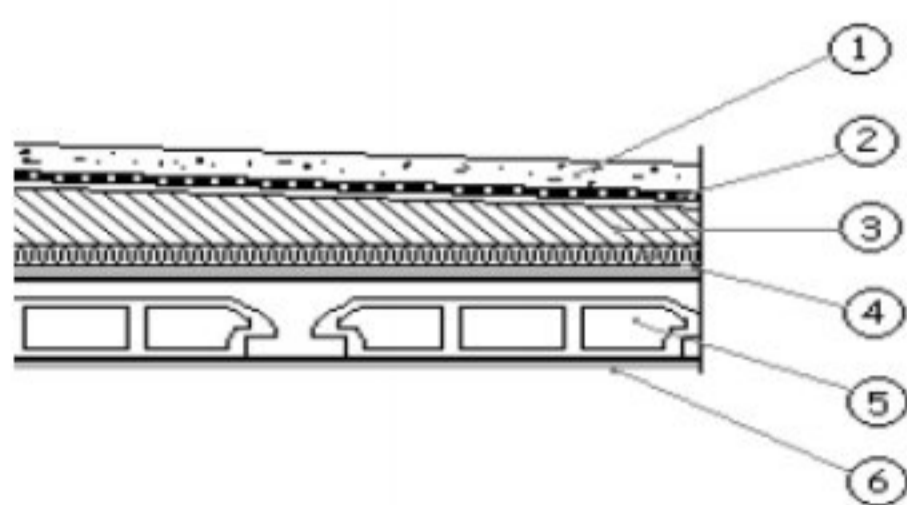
Coupe transversale dans Le plancher terrasse inaccessible.
